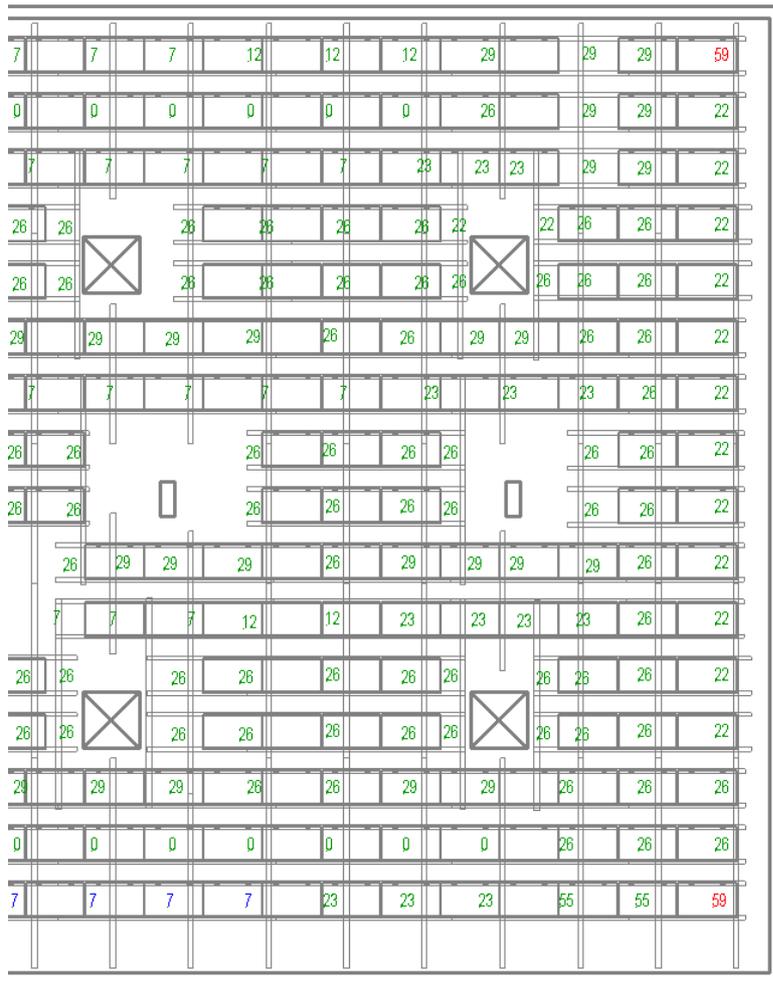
Ballastplan (Planausschnitt als Beispiel)
